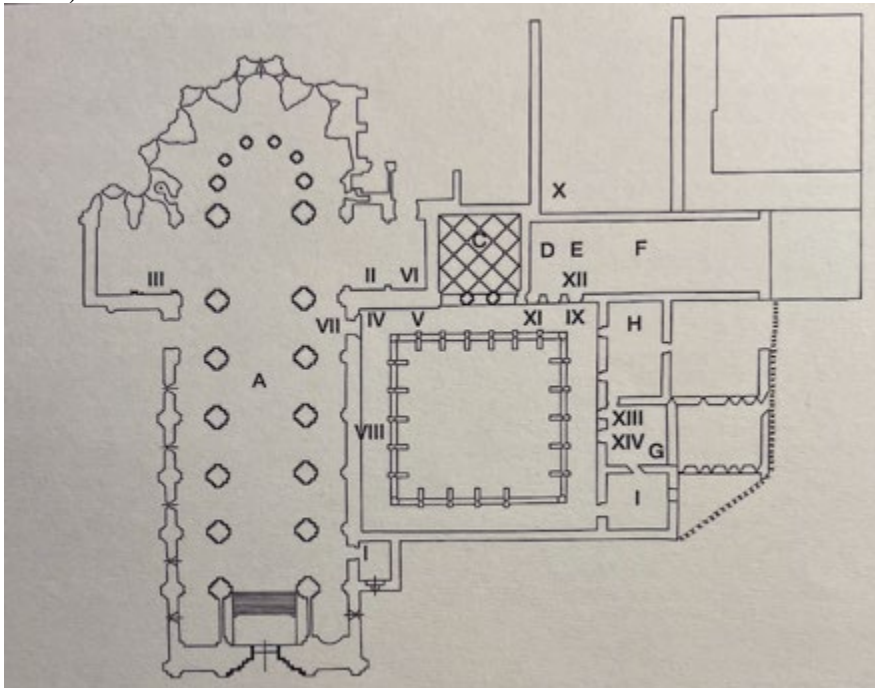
Fitero, Santa María, Grundriss, Mittelalterlicher Plan des unteren Stockwerks, Fernández Gracia, 1997.
